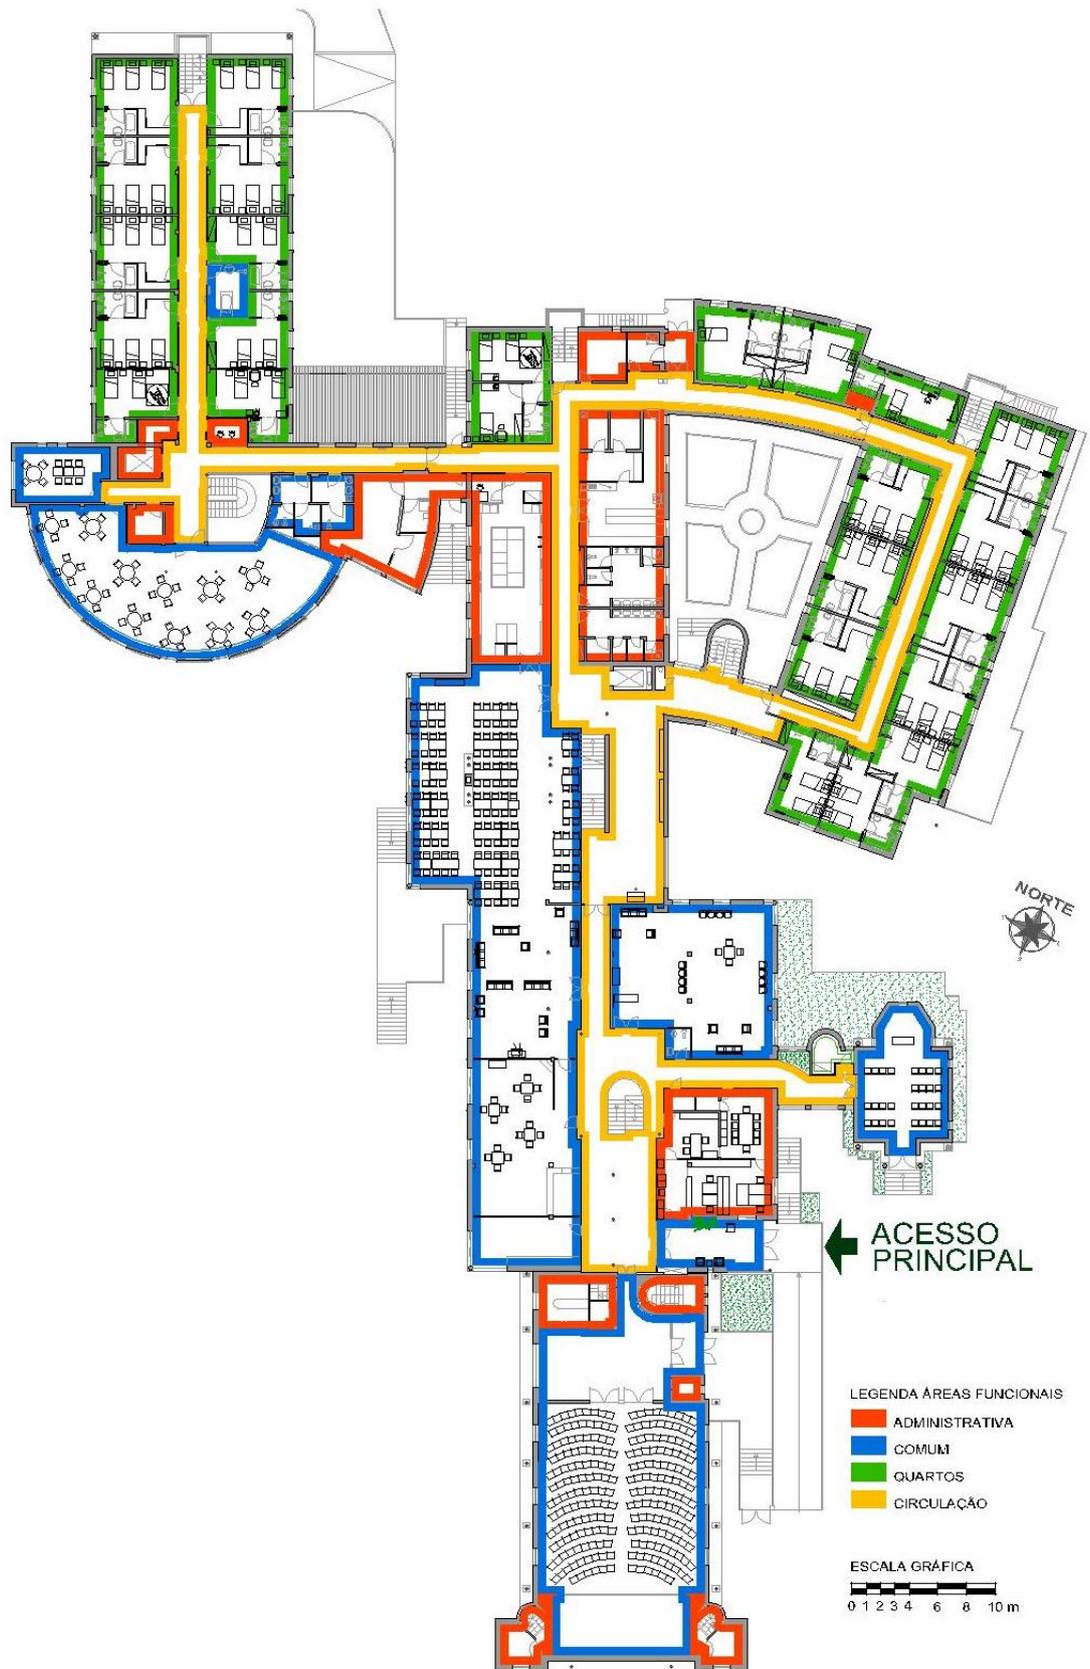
ILPI 1 - Setorização de áreas funcionais - 2º pavimento.
